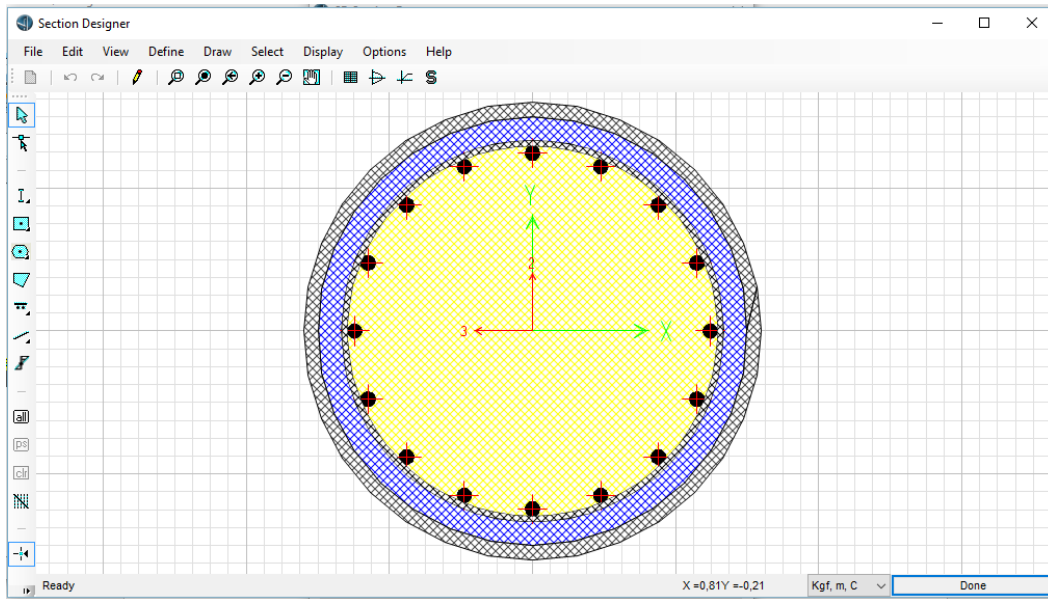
Sección transversal correspondiente a las pilas o apoyos intermedios del puente
